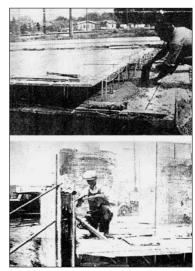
, 가렛 건설공법 (Garrett construction system) 과정
